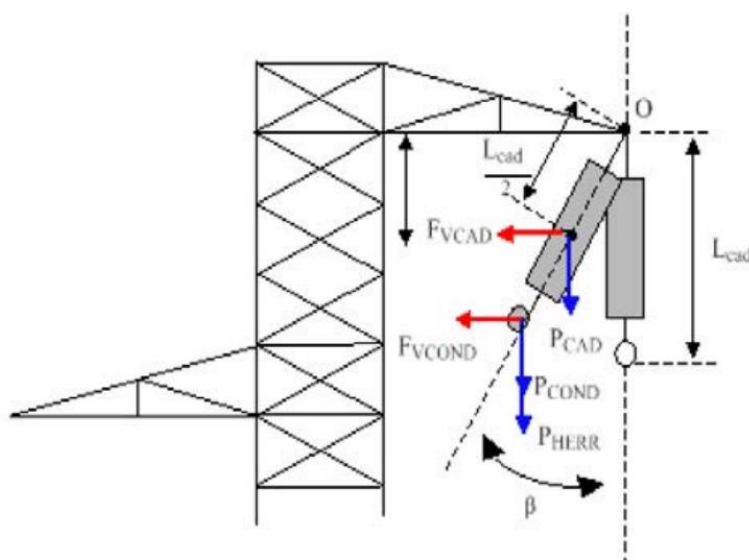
DESVIACIÓN DE LA CADENA DE AISLADORES
